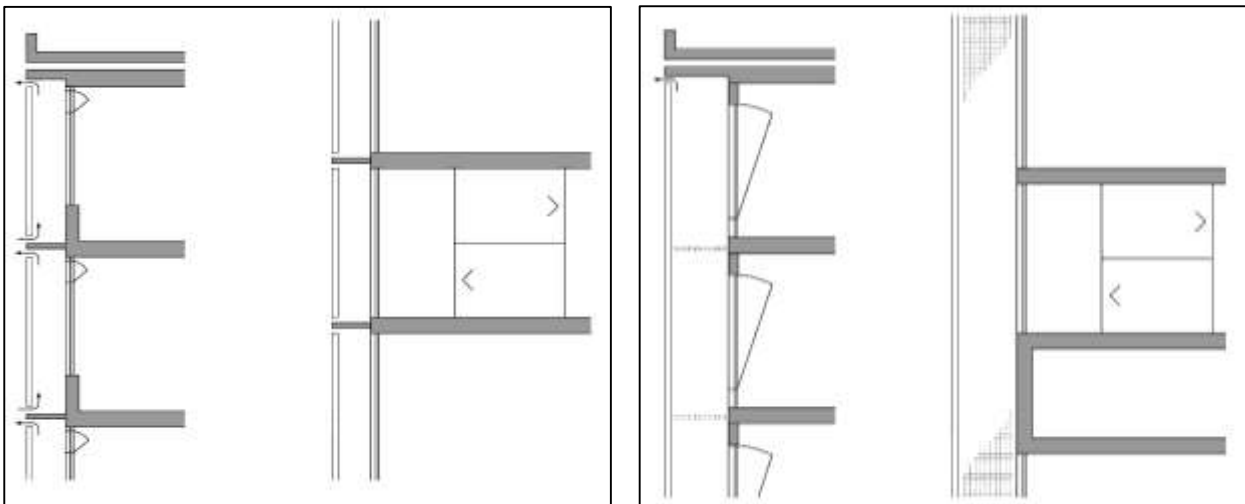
(li.): Typ A: Doppelfassade mit Segmentierungen mit Feuerwiderstand [N1]
